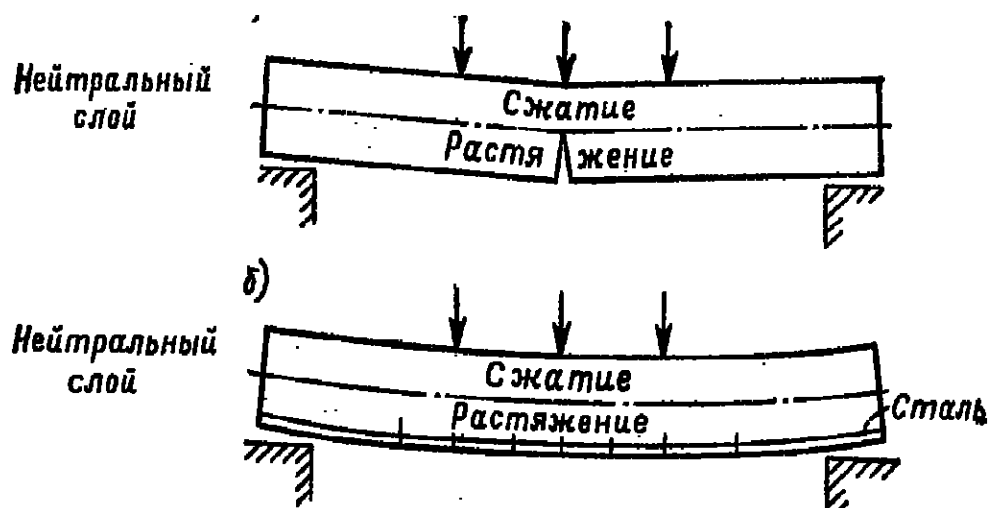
Бетонная и железобетонная балки под нагрузкой
